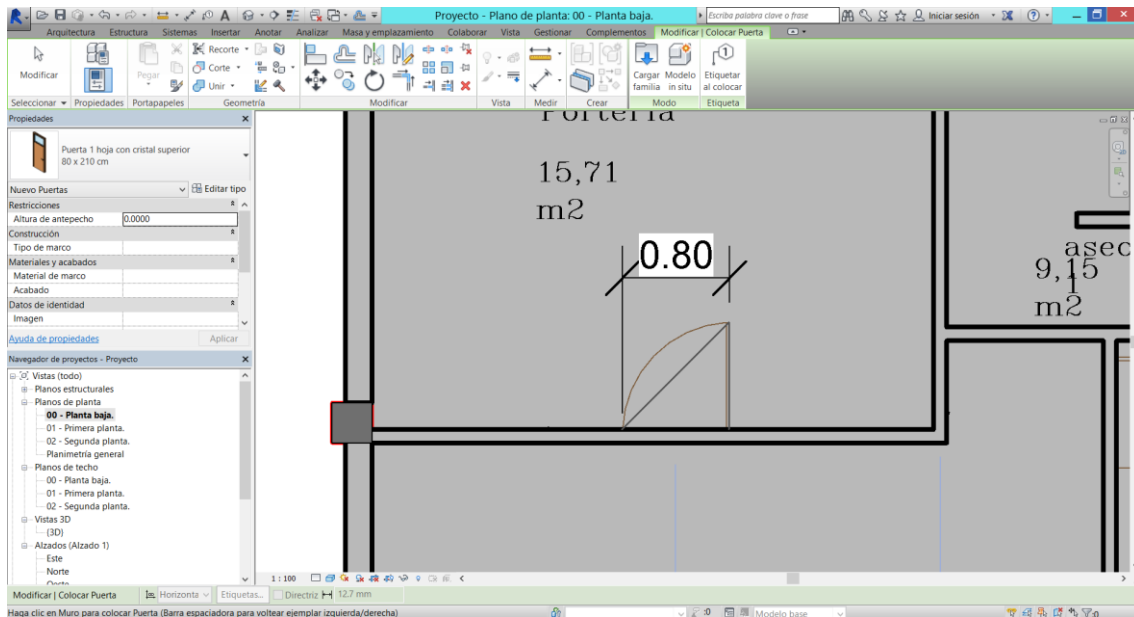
Colocación de la puerta interior: Puerta 1 hoja con cristal superior 80 x 210 cm. Fuente: Elaboración propia.
